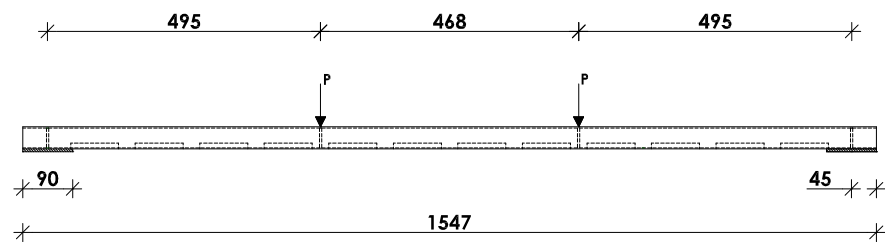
Alçado do ensaio tipo 150×1.5\_Fyy\_Liso (dimensões em mm).
